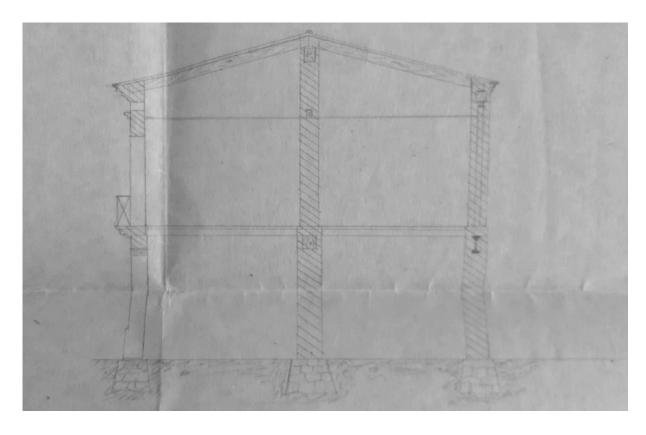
Sección edificio con detalle cimentación (1917). (Fondo Sandro Pons Romaní)
